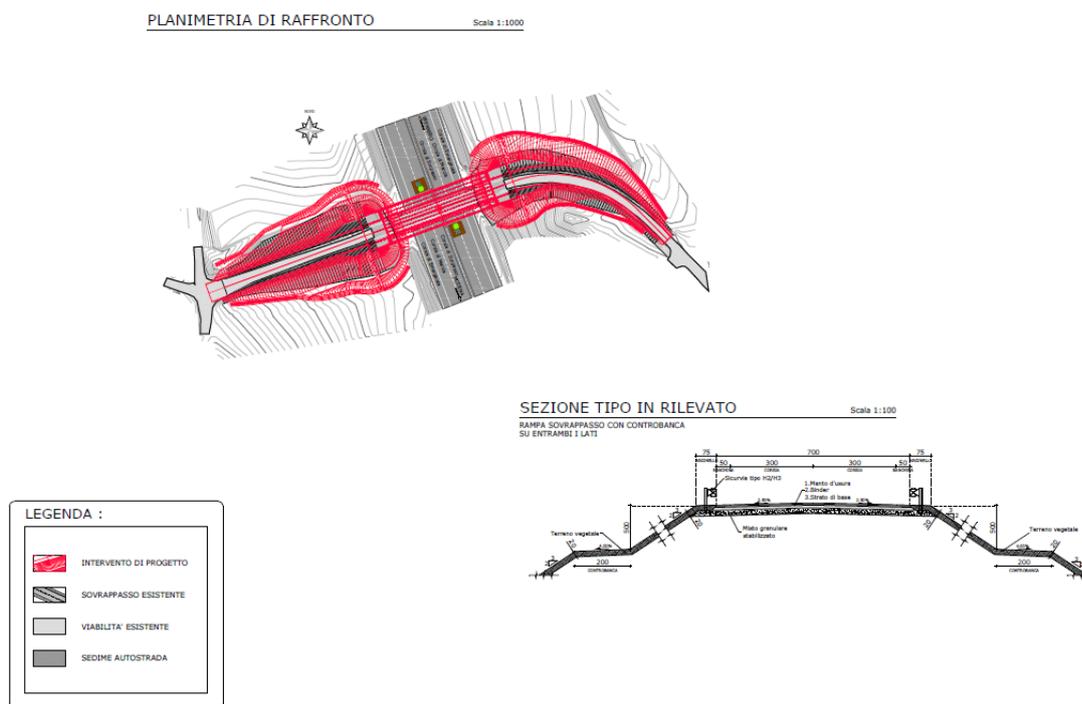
Planimetria di raffronto stato attuale - stato di progetto - Planimetria e sezione-tipo del sovrappasso (Stralcio da Elaborati grafici)
